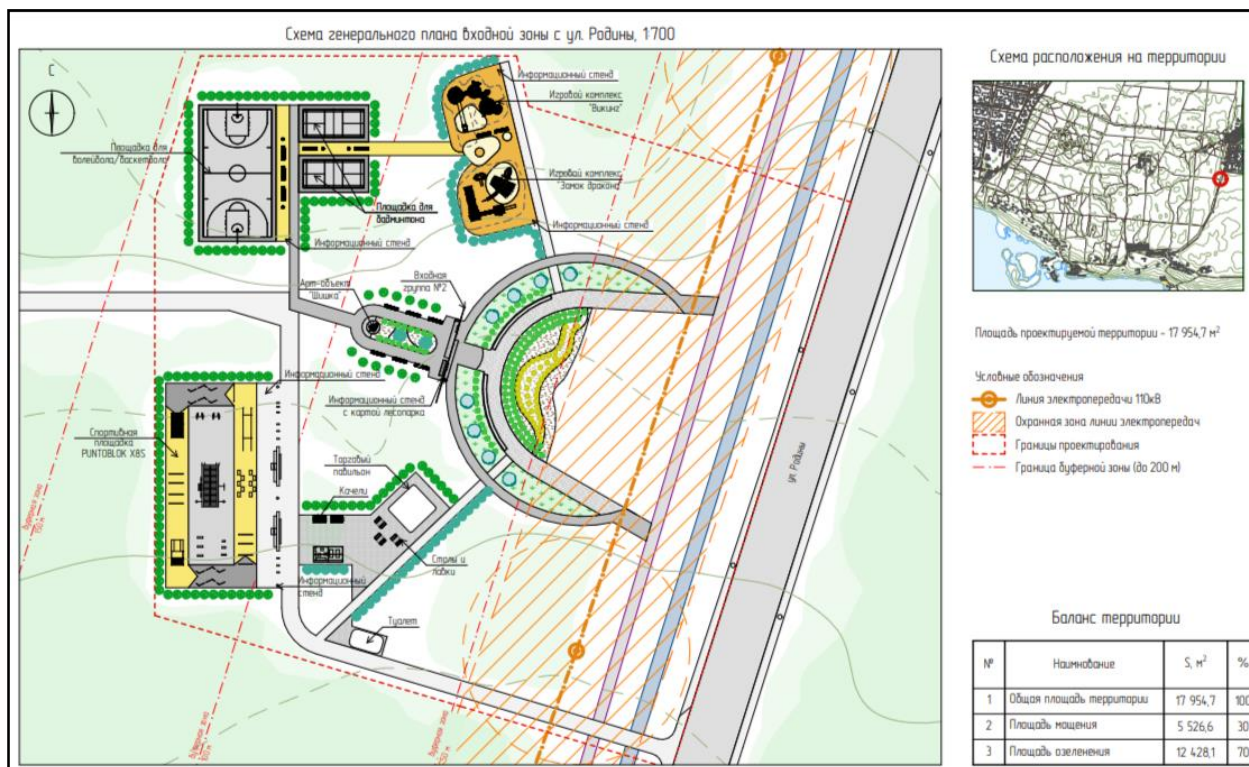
Схема генерального плана входной зоны с ул. Родины
